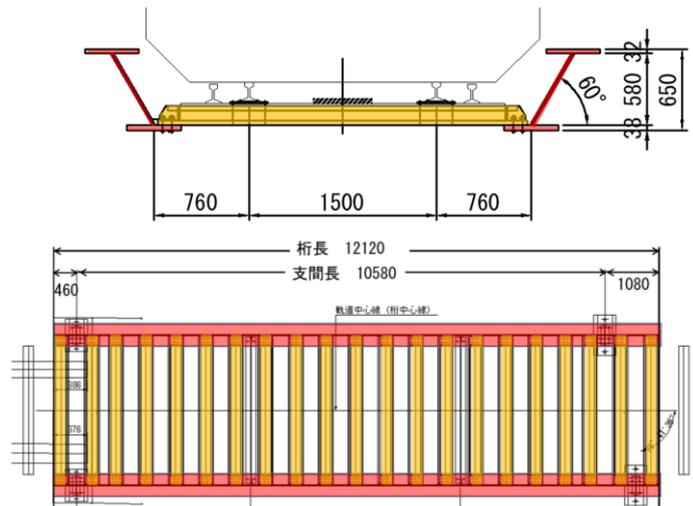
斜ウェブ工事桁 (A2 桁断面図・平面図)
